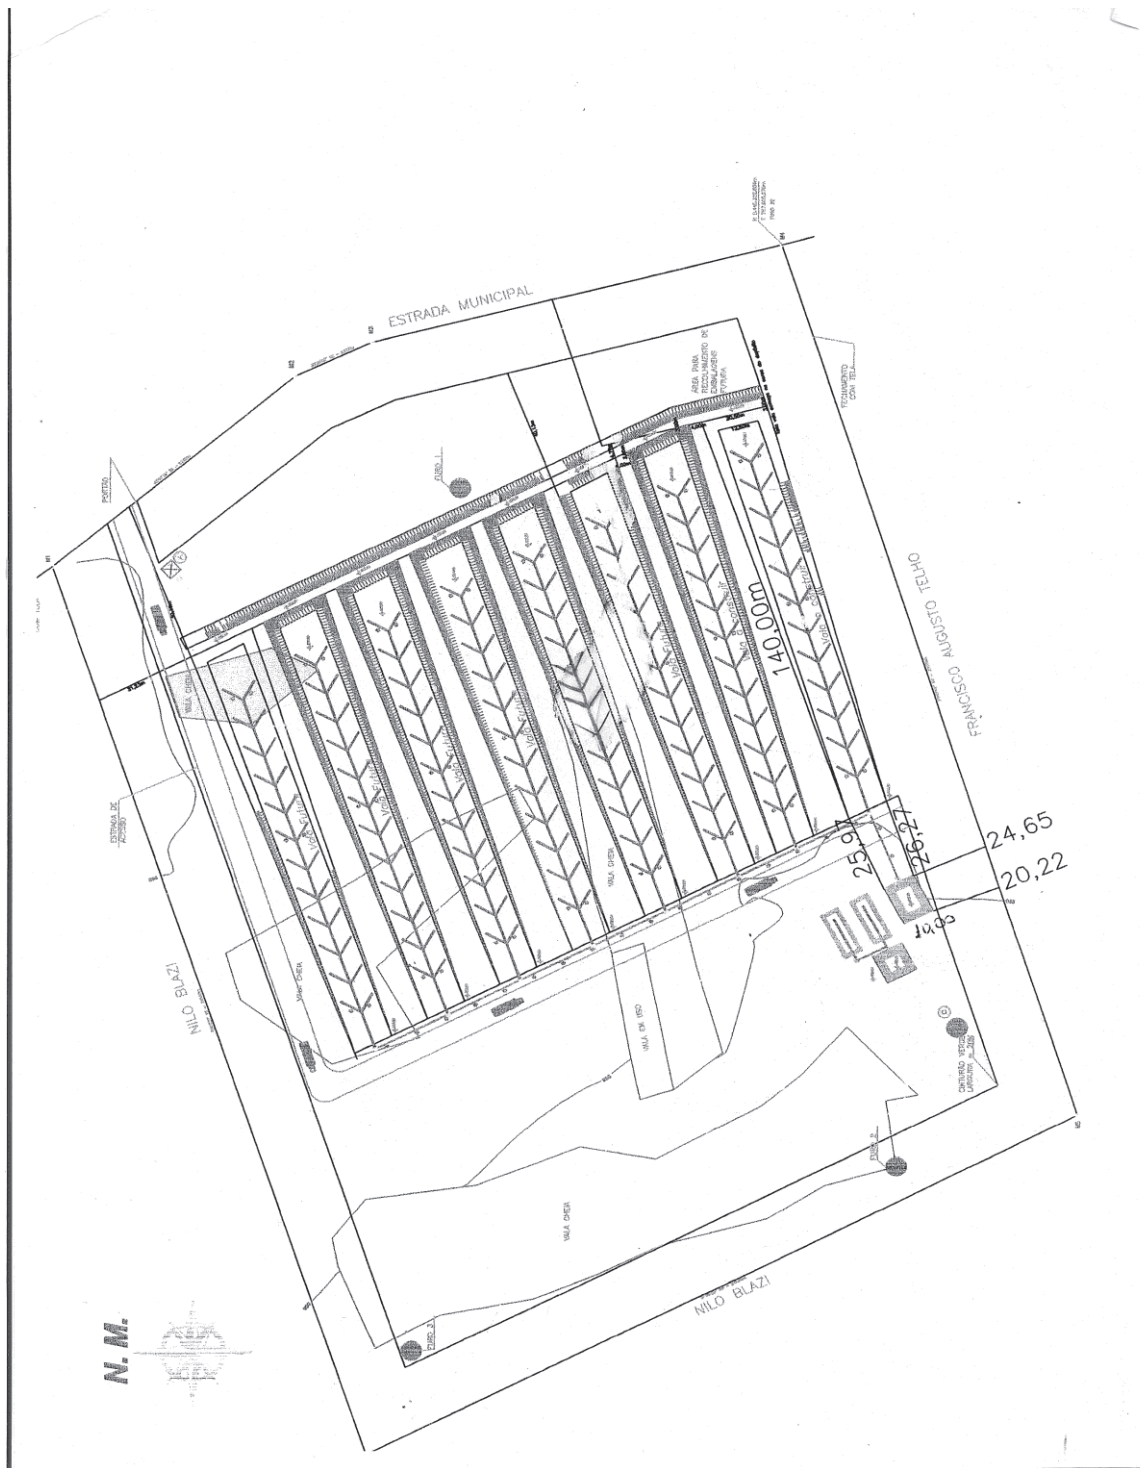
Planta Baixa do Aterro Sanitário de Vianópolis – GO.
